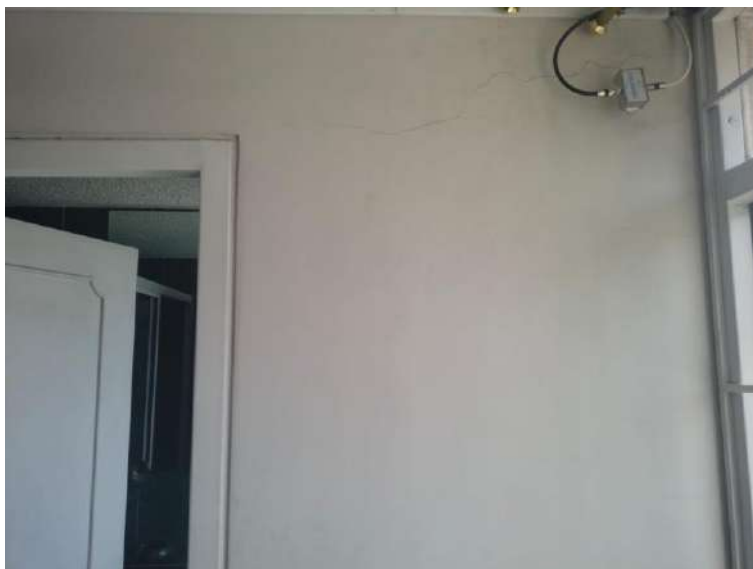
Fisura presente en planta de segundo en muro divisorio. Fuente: Propia.
